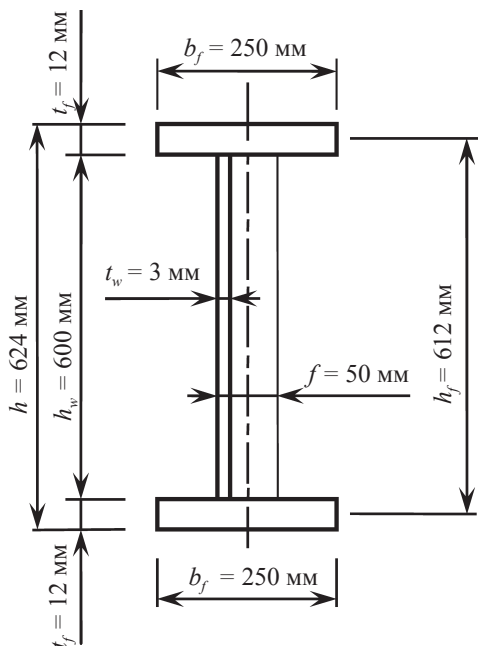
Поперечное сечение балки с волнистой стенкой
